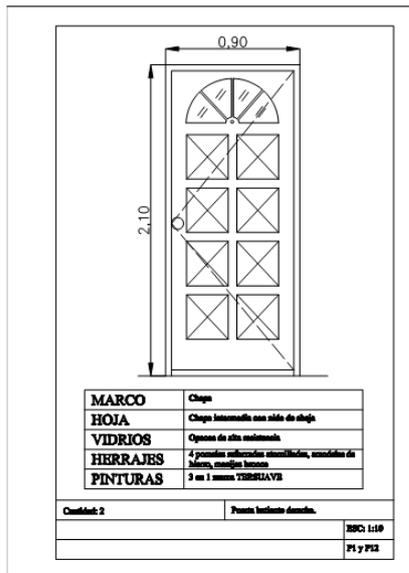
Planos de carpintería (Planta y detalles de cada abertura)
